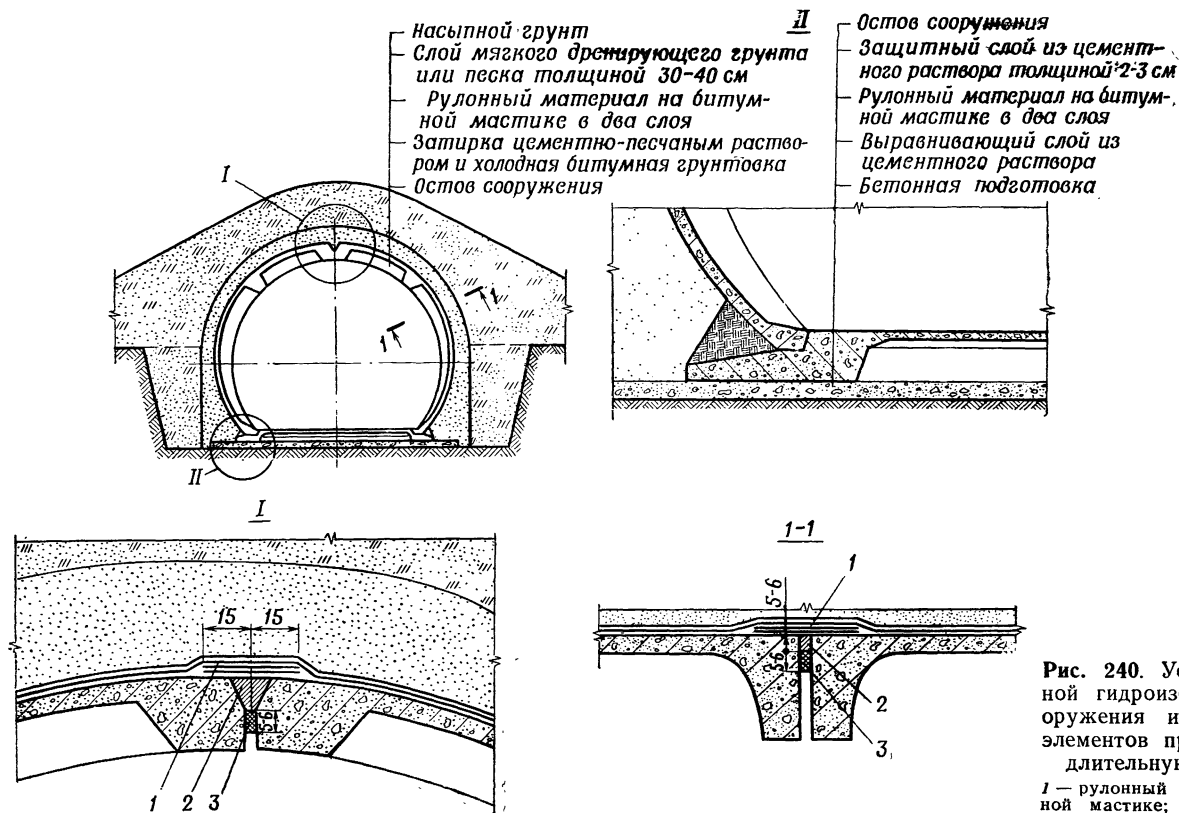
Устройство оклеечной гидроизоляции остова сооружения из железобетонных элементов при возведении на длительную эксплуатацию:
